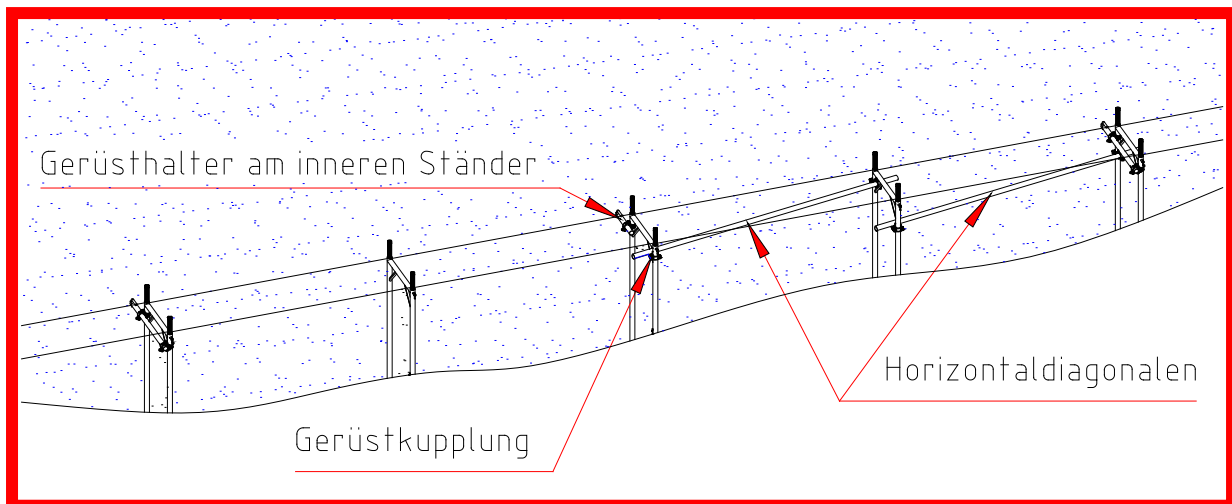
Anschluss des Gerüsthalters nur am inneren Ständer
